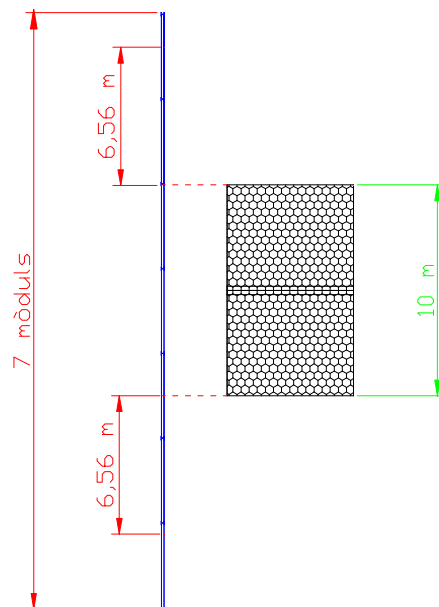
Croquis vista planta situació pantalla respecte R7.
